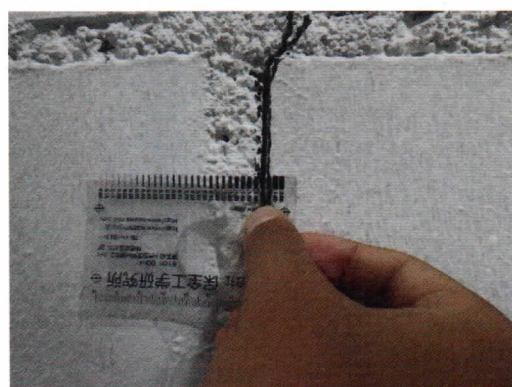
Espesor de grieta de 1.7mm (Cara Norte) para una distorsión de 1/400.
